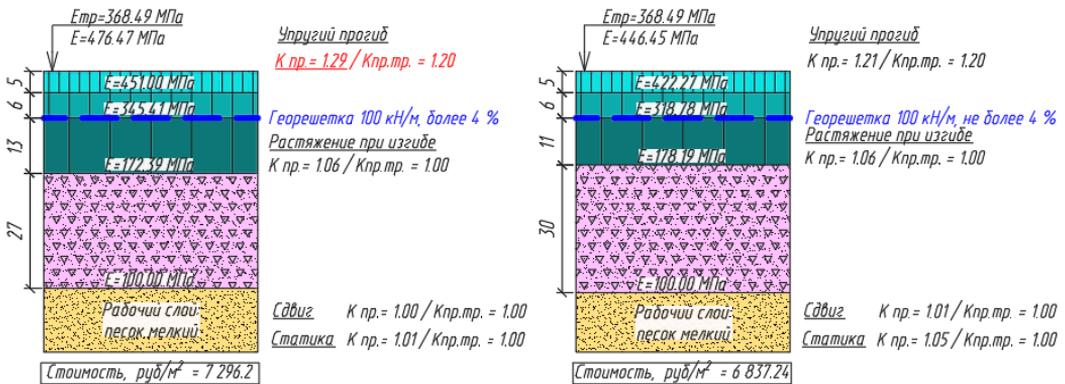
Результаты расчета конструкции дорожной одежды с армированием асфальтобетонного покрытия георешеткой прочностью 100 кН/м
